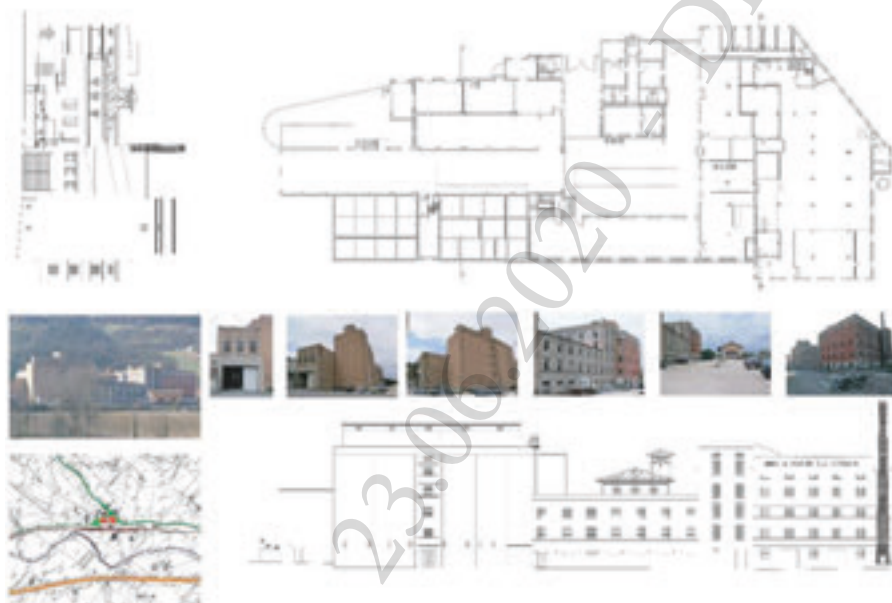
Stato di fatto (pianche, prospetti e sezioni);
